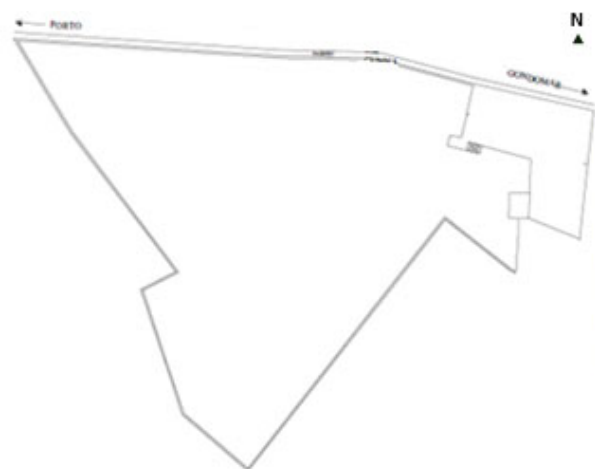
Representação esquemática do terreno e das construções existentes (A, B e C)
